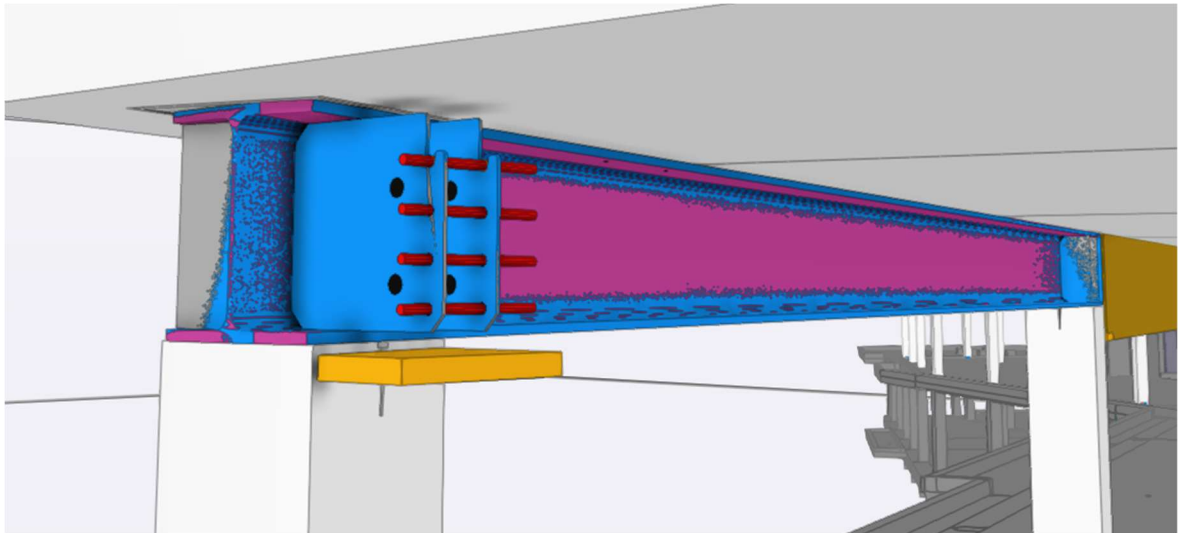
Ligação viga-viga 2 (Fonte: Software Tekla, 2023)
